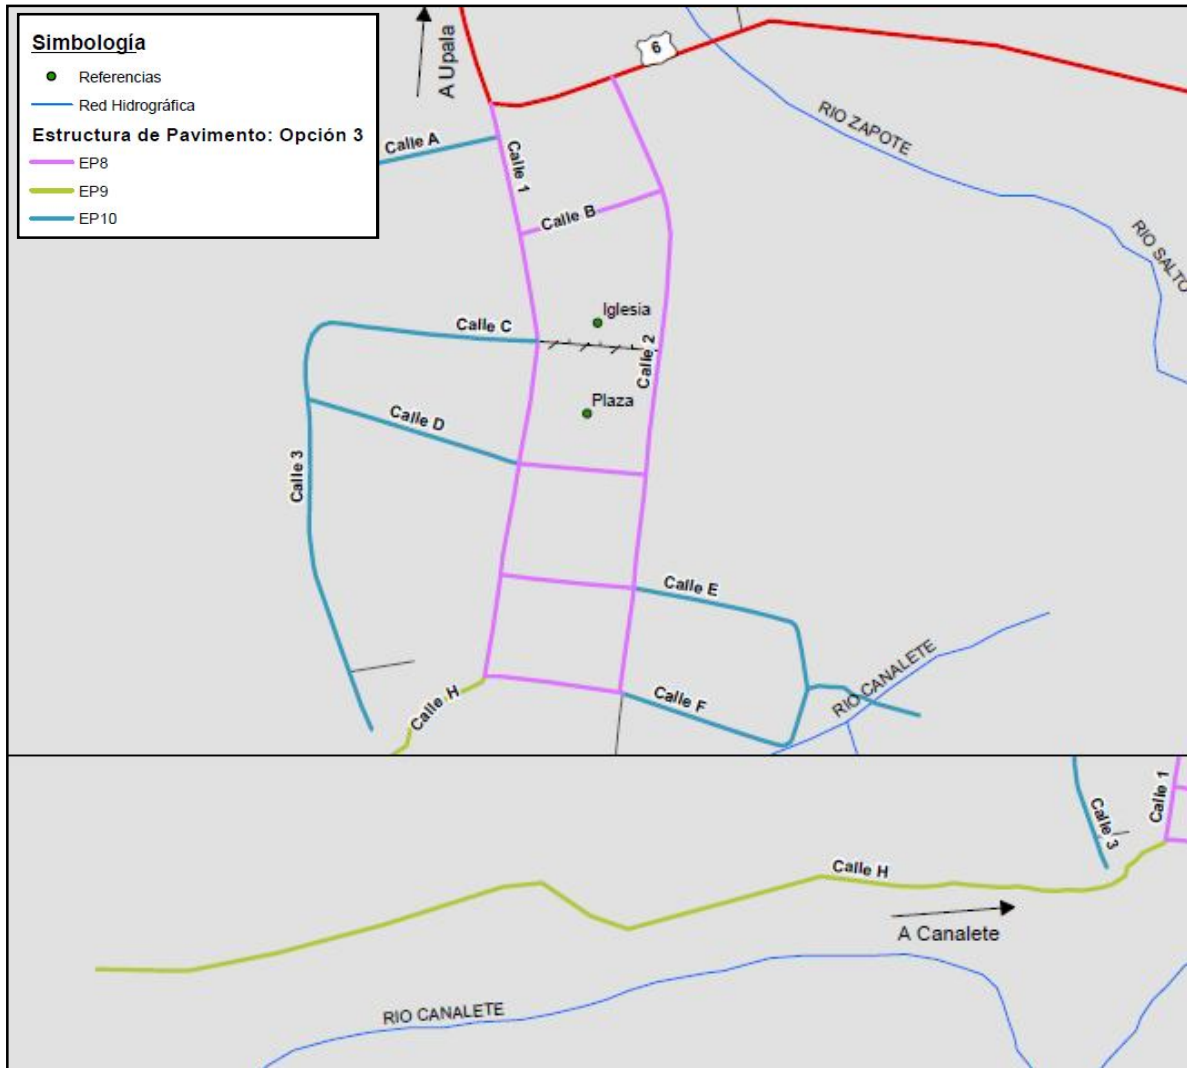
Distribución de la estructuras de pavimento para la Opción 3.
